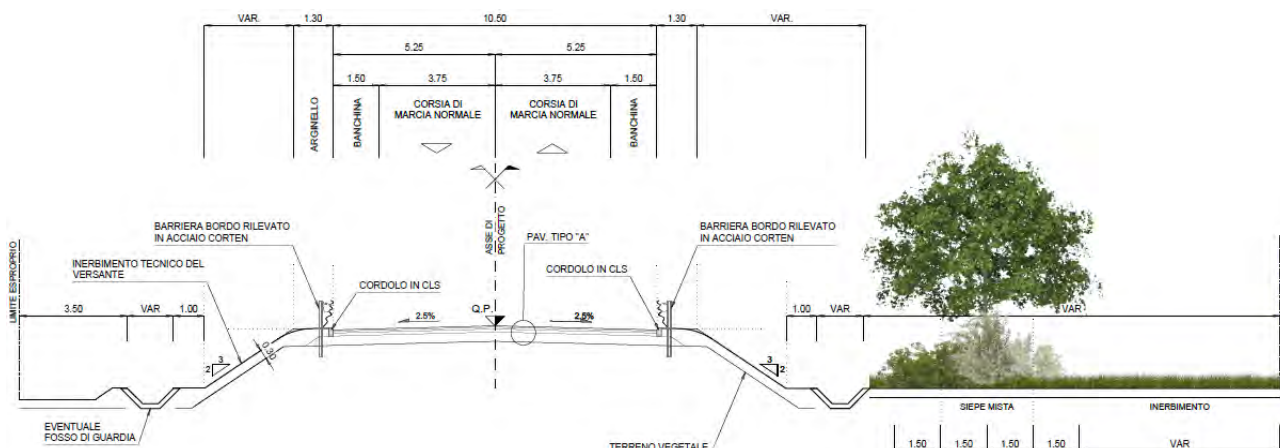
Sezione tipologica del tratto stradale in rilevato con applicazione della Siepe mista
